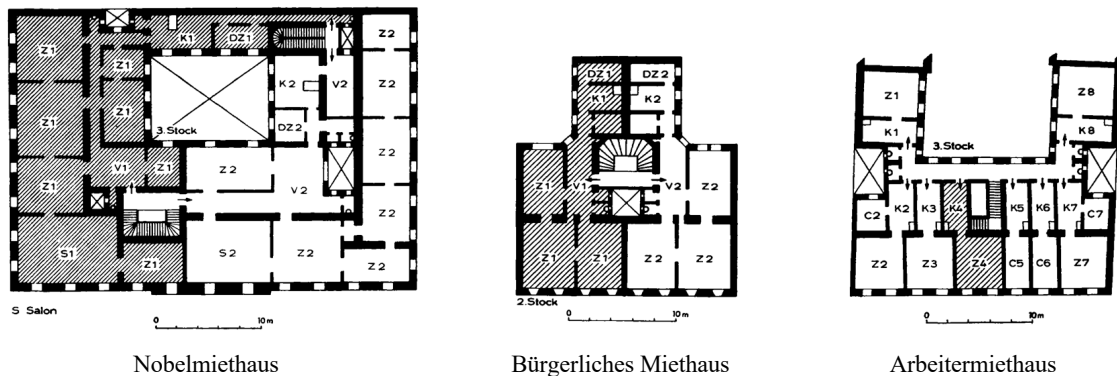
Grundrisse verschiedener Zinshaustypen¹³
